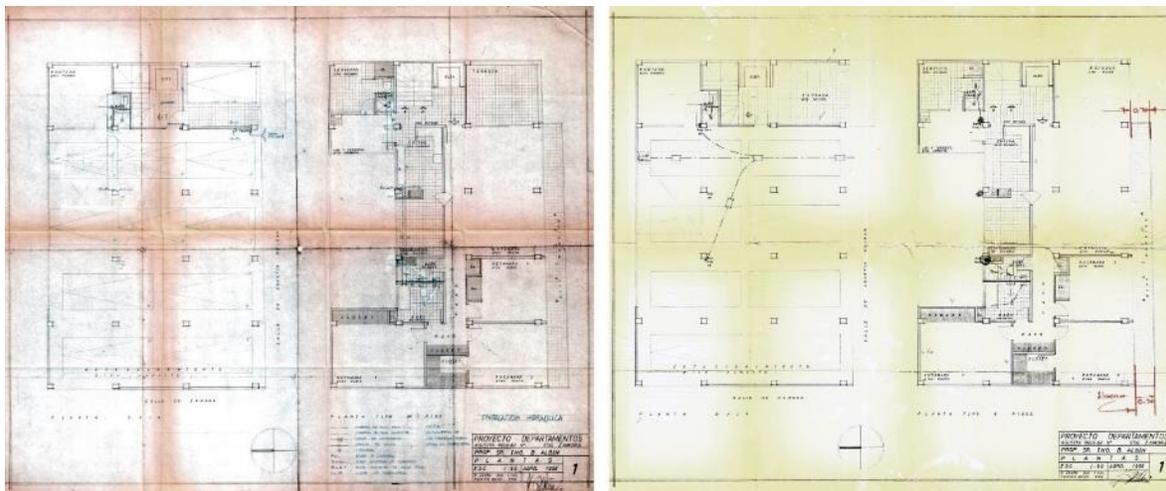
Planos de proyecto -no construido- del edificio ubicado en Agustín Melgar núm.33, dos opciones de proyecto de planta baja y tipo, abril 1956
